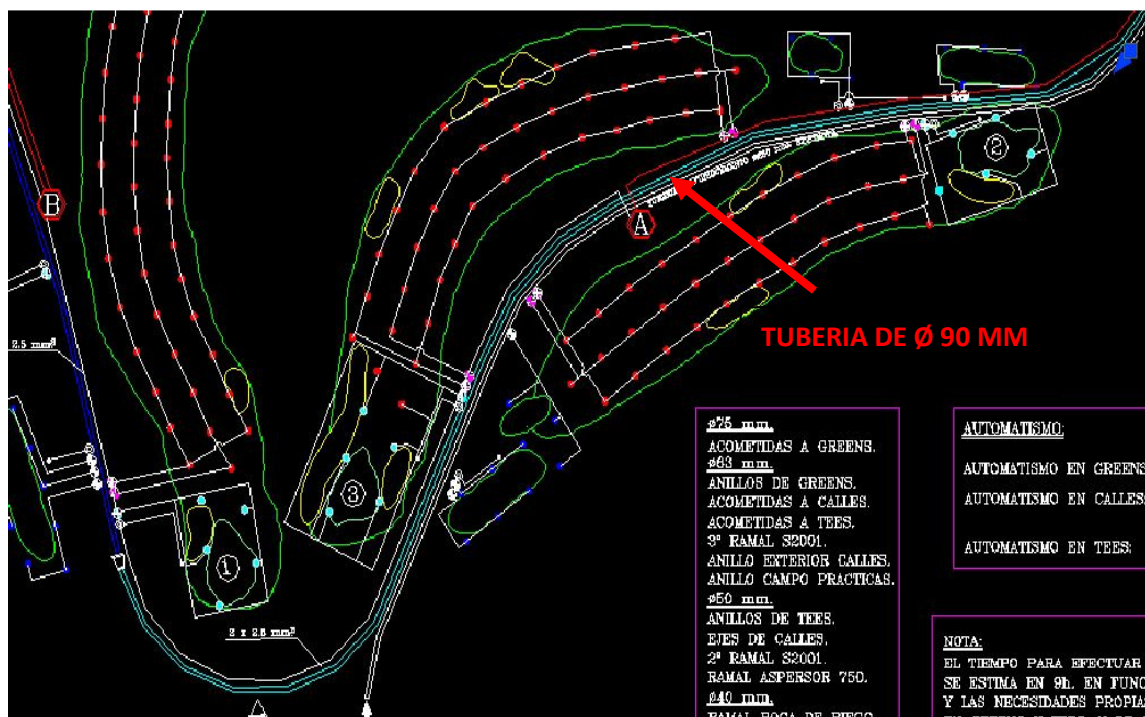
En color azul claro se puede observar el tramo de tubería de Ø 90 mm que abastece a las calles #2 y #3.
